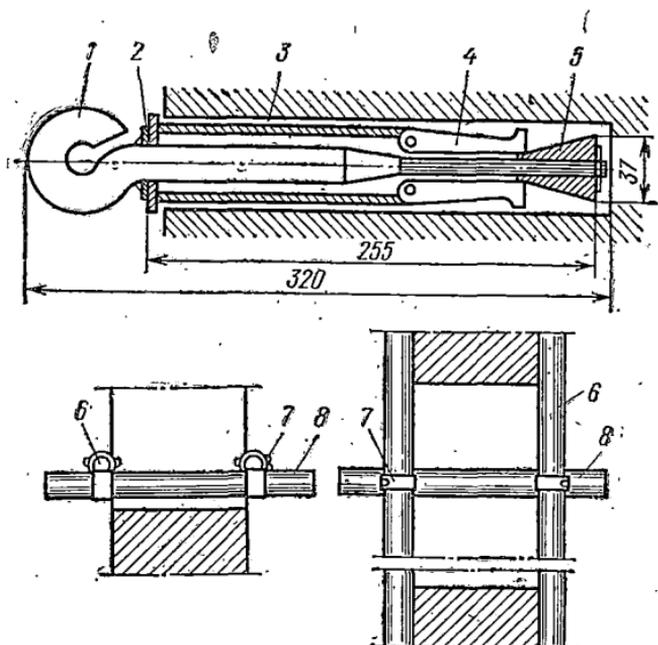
Инвентарная пробка КБ-3 для крепления лесов к стене здания:
